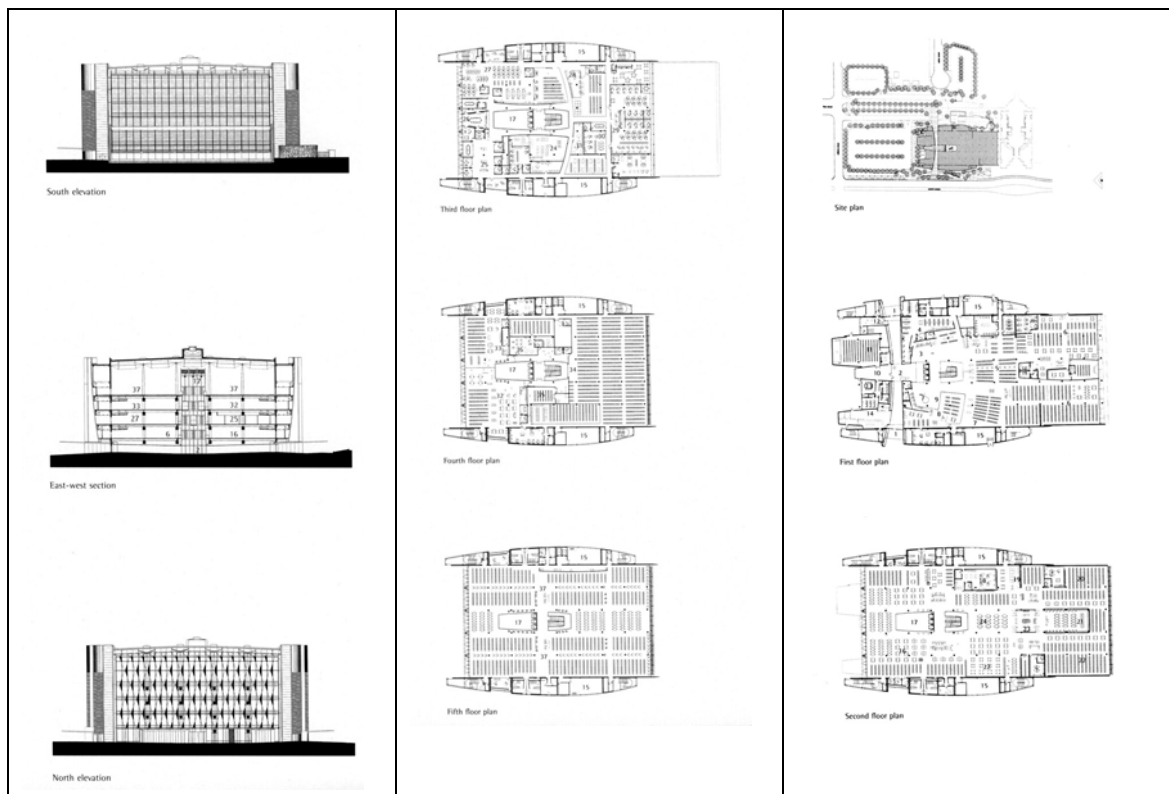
Ansicht, Schnitt und Grundrisspläne
